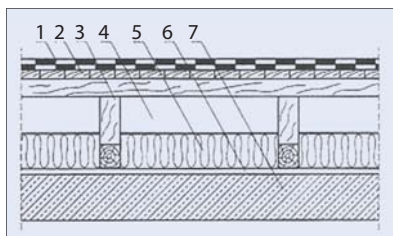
| Stropodach wentylowany kanalikowy: 1 – hydroizolacja, 2 – wylewka betonowa, 3 – szczelina wentylacyjna, 4 – termoizolacja, 5 – paroizolacja, 6 – strop
